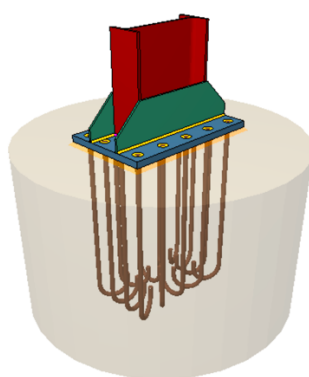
Placa de anclaje pilares interiores del pórtico de fachada.
